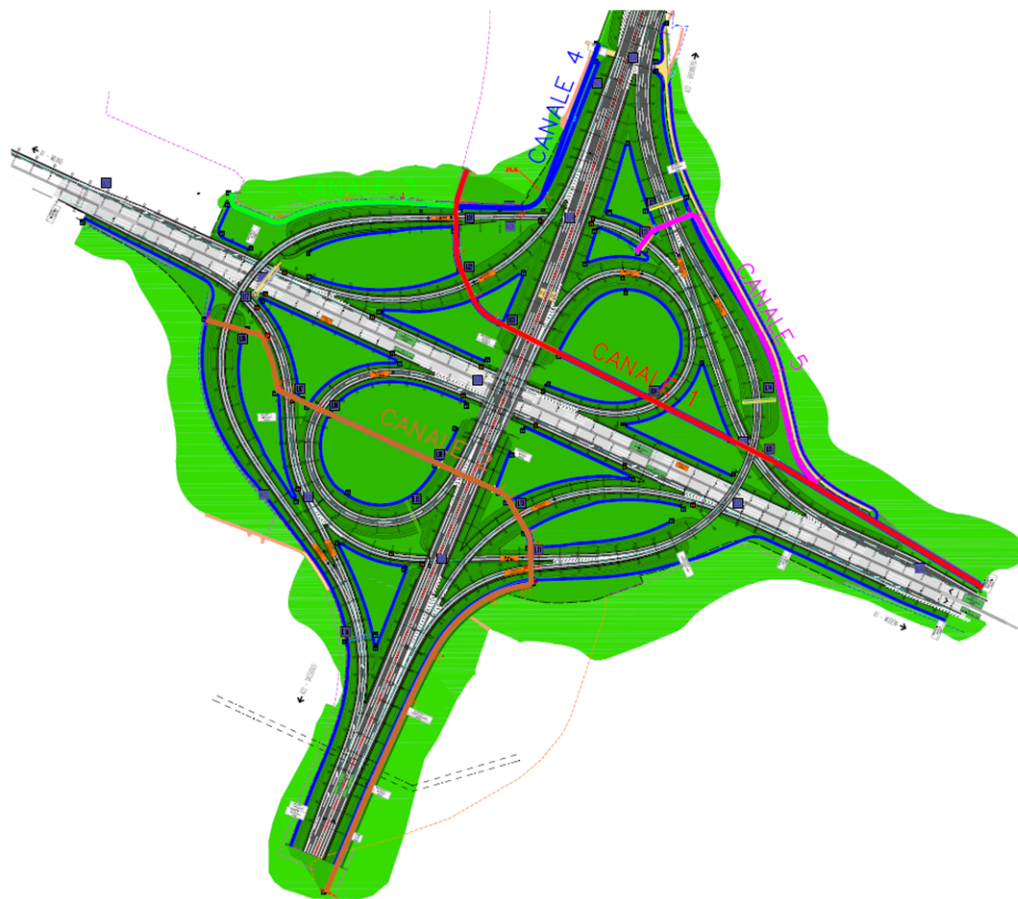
Planimetria del nuovo svincolo autostradale con canali di progetto.
